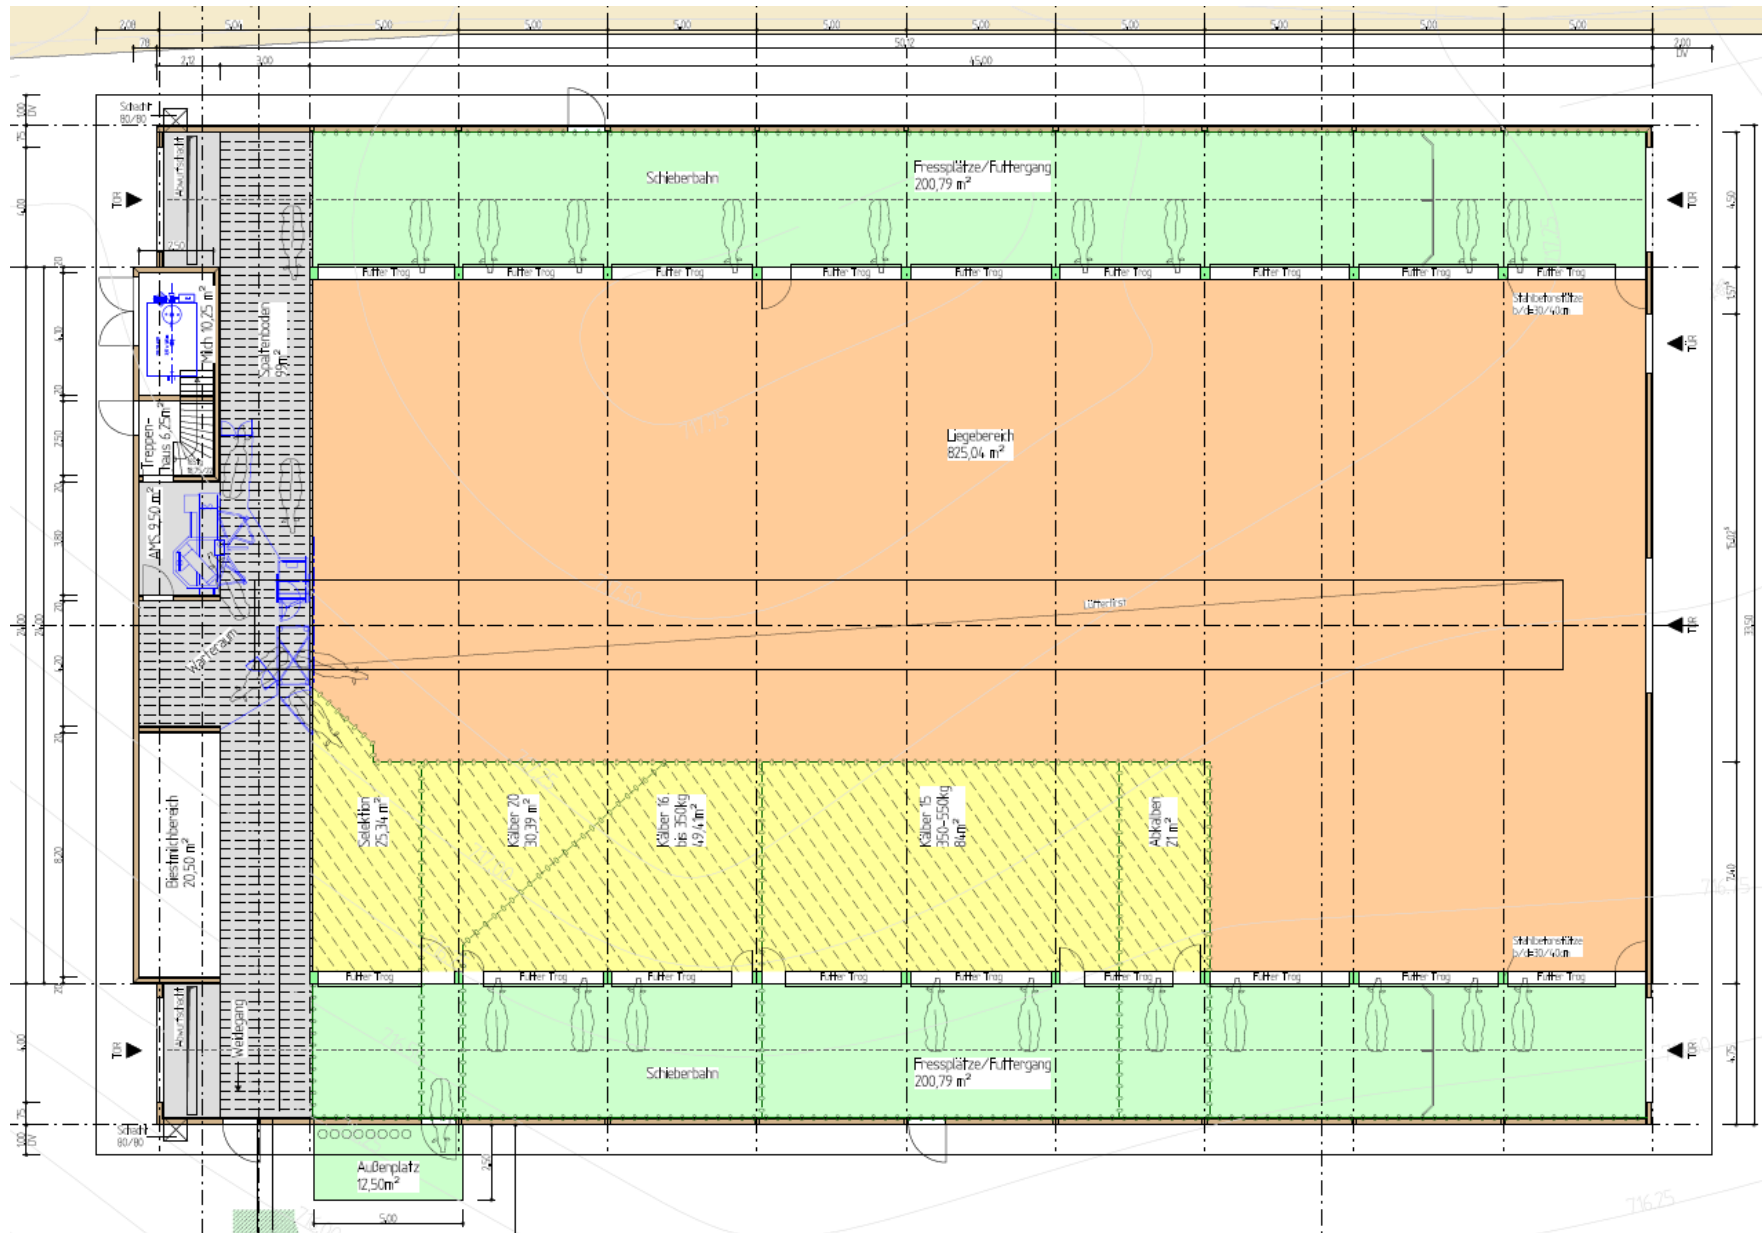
Grundriss Stallkonzept 14 (Plan: Bernd Sättle, Löffingen-Unadingen)
